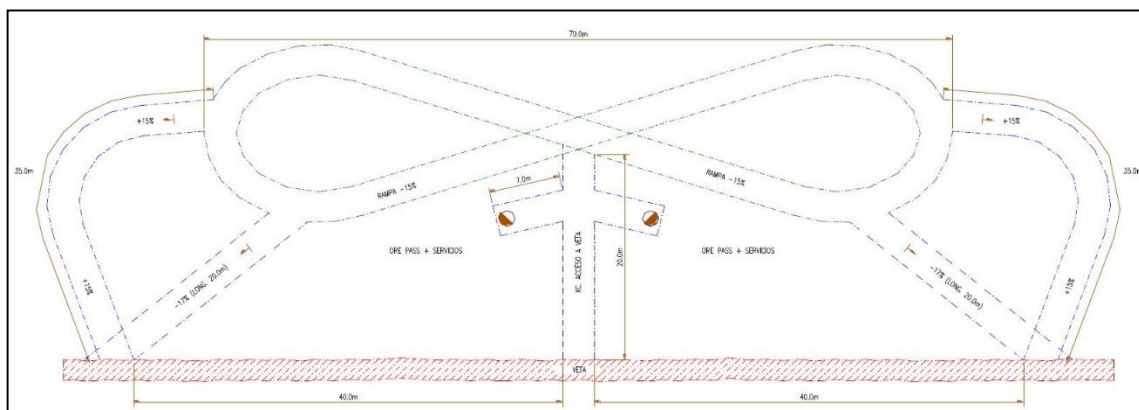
12 Rampa con dos accesos. Vista en Planta.
